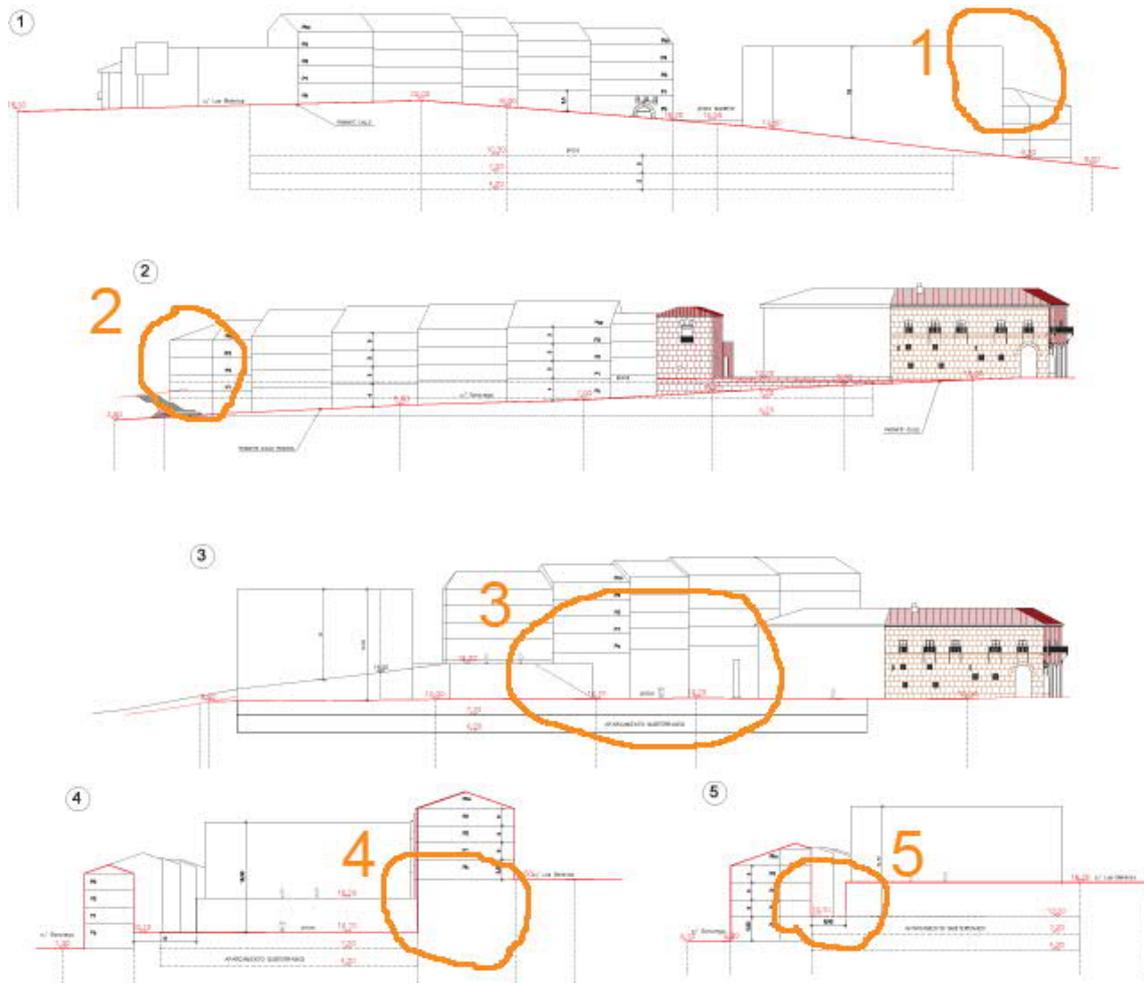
Secciones y alzados de la ordenación del Estudio de Detalle con anotaciones.
